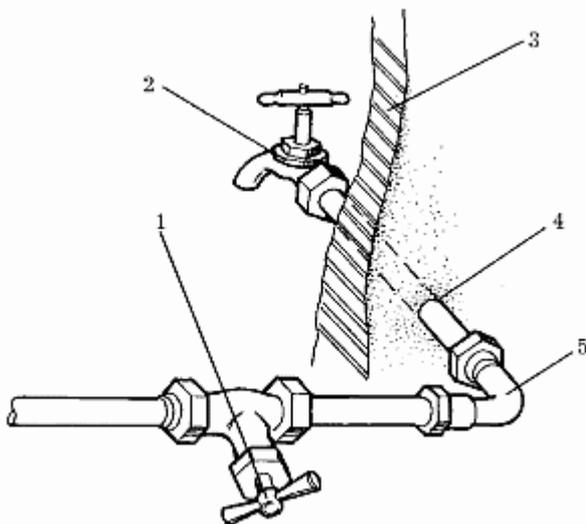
Вывод наружного крана: 1 – перекрывающий вентиль; 2 – наружный кран; 3 – стена дома; 4 – отверстие в стене; 5 – уголок.
